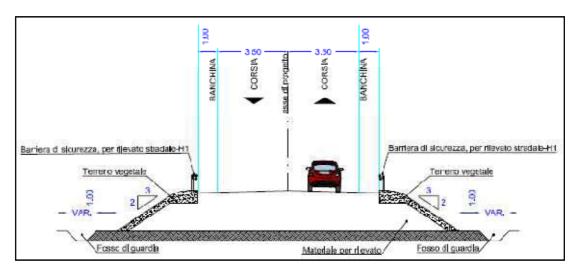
Sezione tipo in rilevato, prolungamento via Federigo Enriques
